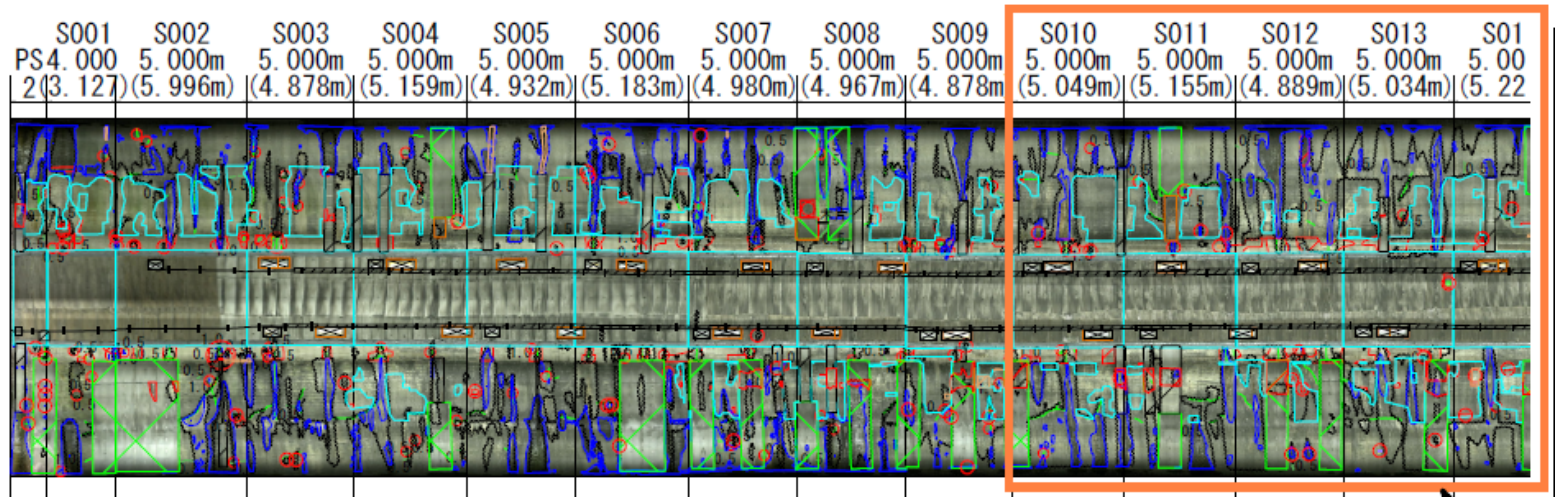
外力作用の可能性のある箇所のひび割れの進行、段差の有無等の確認①
